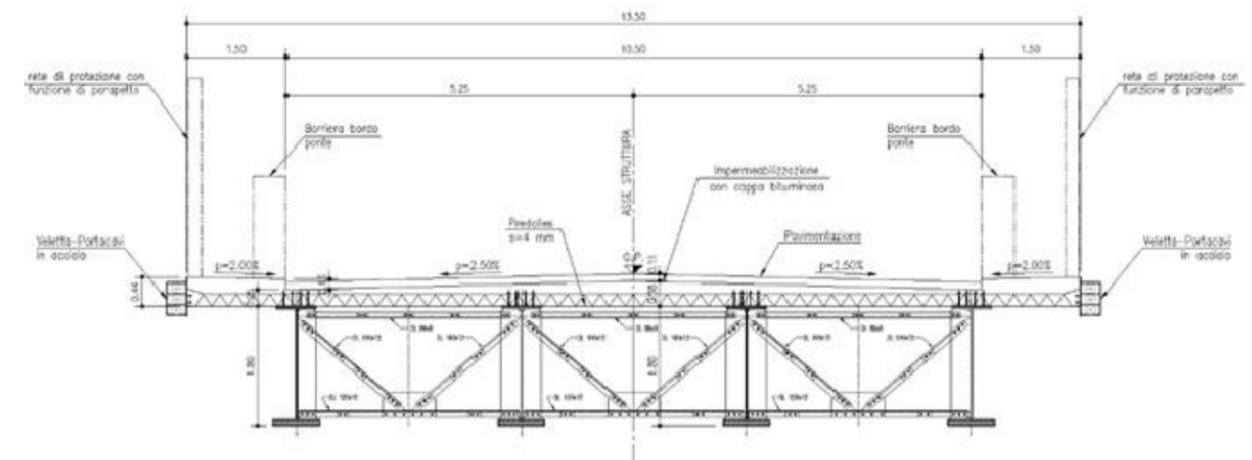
Sezione longitudinale del cavalcavia di svincolo
